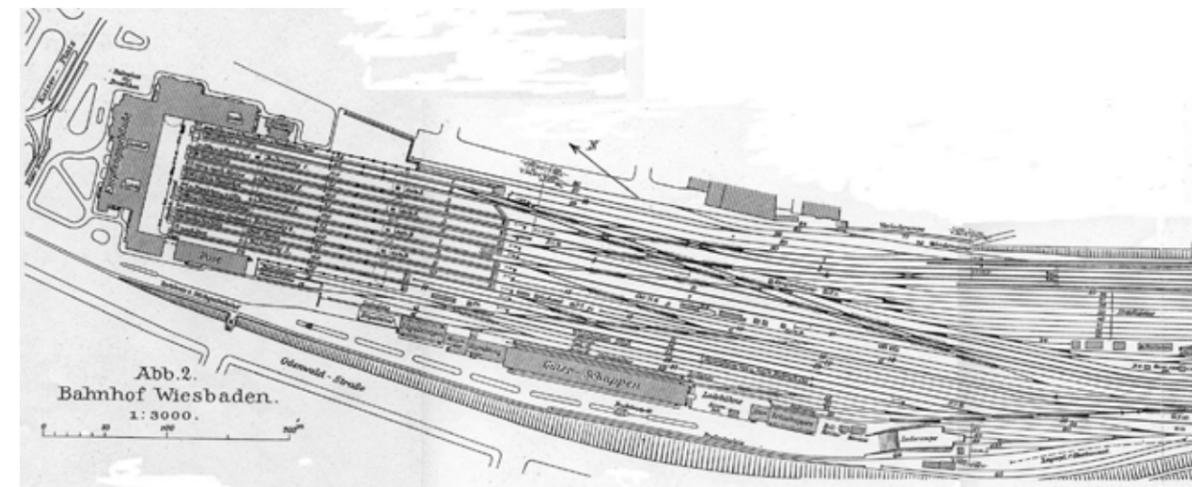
Lageplan des Stückgutbahnhofes (unten) am Wiesbadener Hauptbahnhof mit den jeweiligen Räumlichkeiten und ihren Funktionen, 1906
